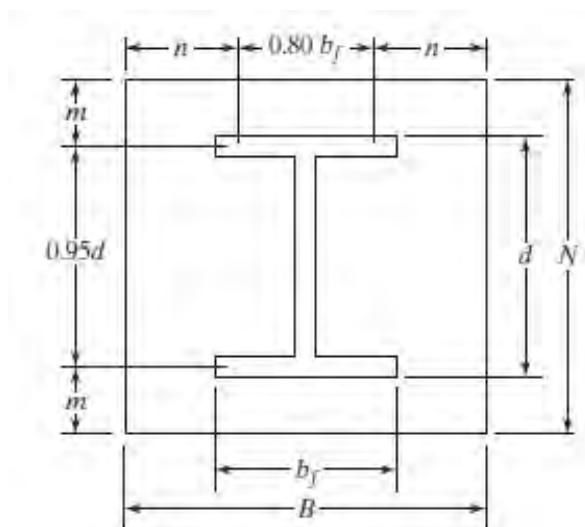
Diseño de plancha de anclaje para el perfil W.
